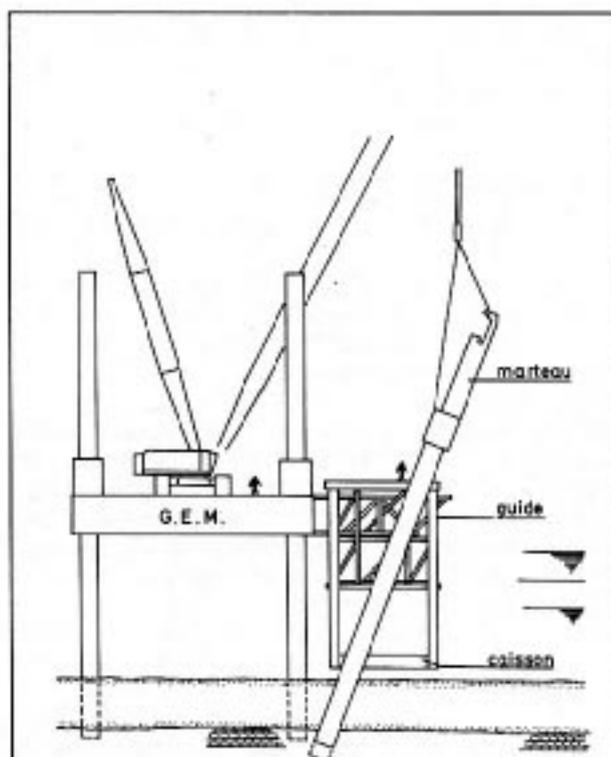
MISE EN PLACE DU CAISSON ET BATTAGE DES TUBES
